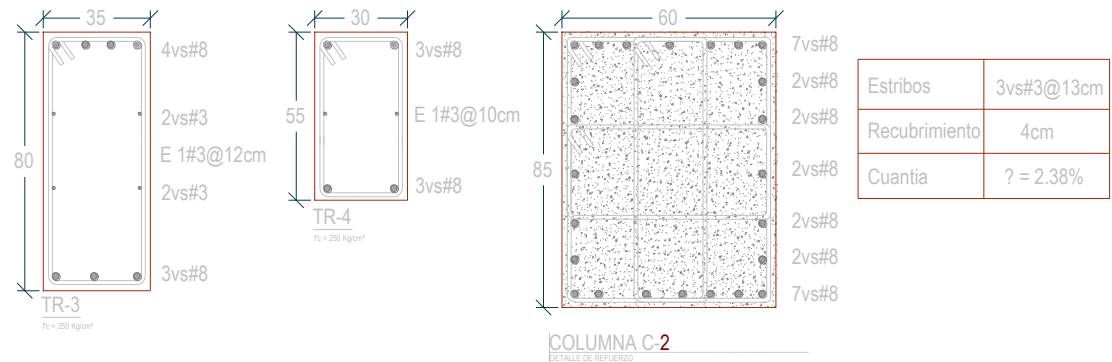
Secciones transversales de edificios diseñados con NTCC-87 (con interacción suelo-estructura y con base fija)
